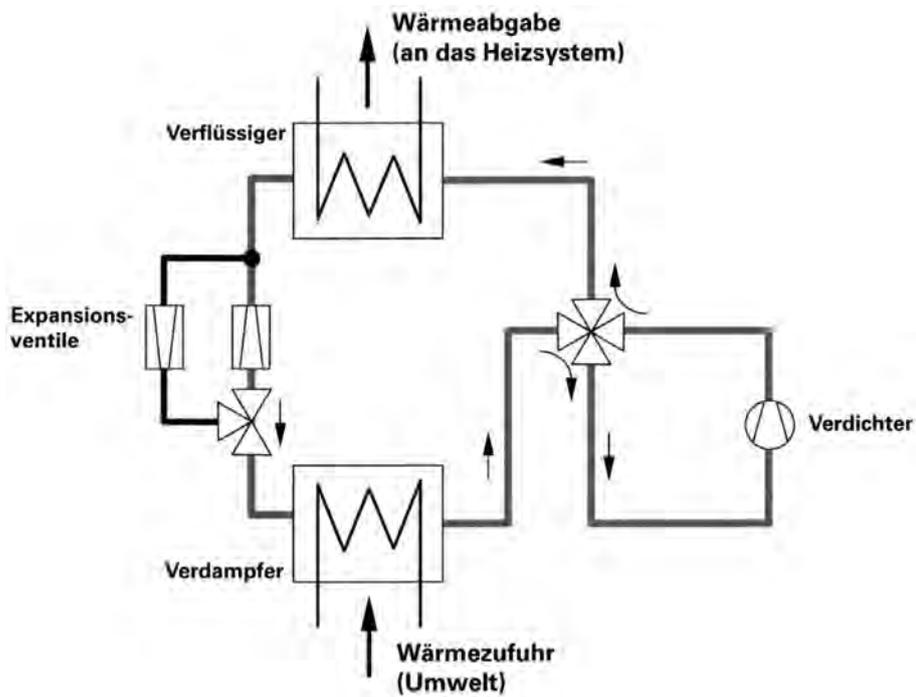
| Funktionsschema einer reversiblen Wärmepumpe – Heizbetrieb
